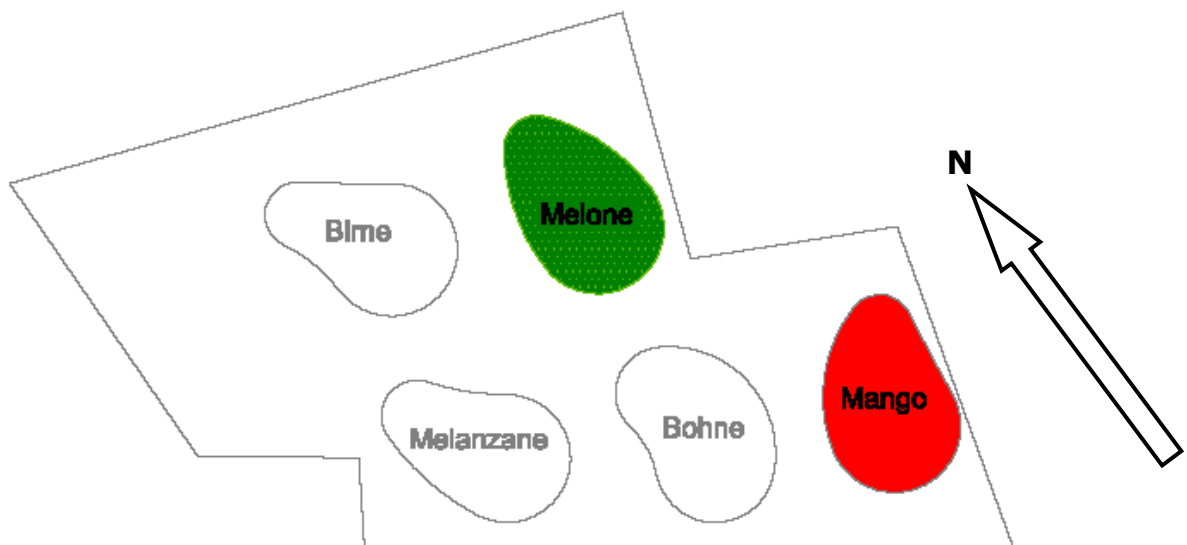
Lageplan der Wohngebäude in der Dreherstraße
